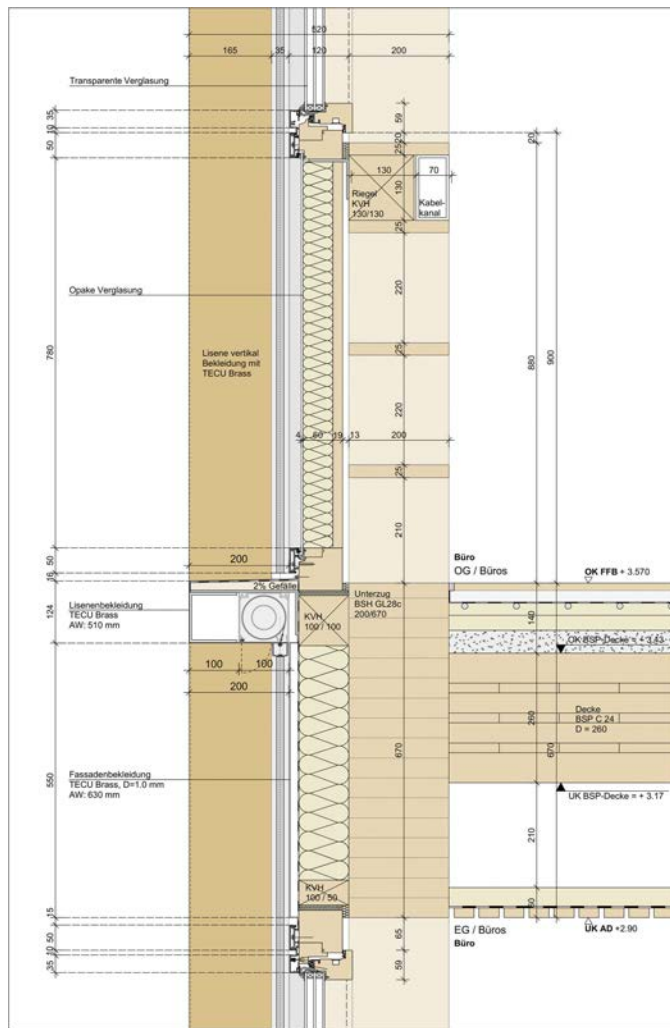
Schnitt Fassade (Quelle: Studio Bornheim)
